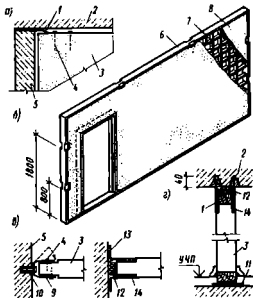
Крупнопанельные гипсобетонные перегородки:
